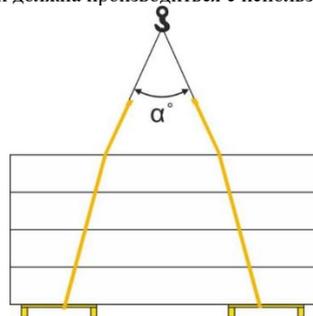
Разгрузка армированных изделий с использованием мягких строп
